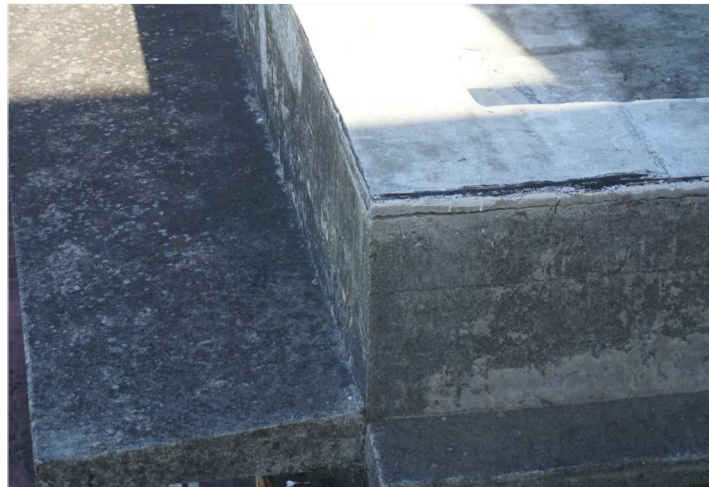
FISURA HORIZONTAL EN PRETEL
